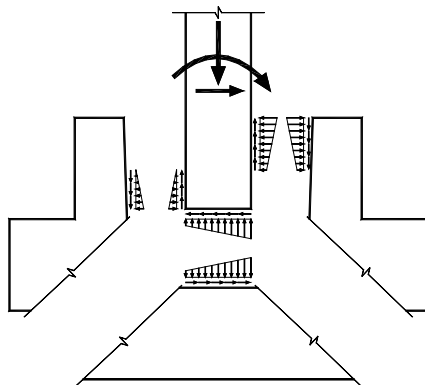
Ligação pilar-fundação em cálice - tensões de contacto.
